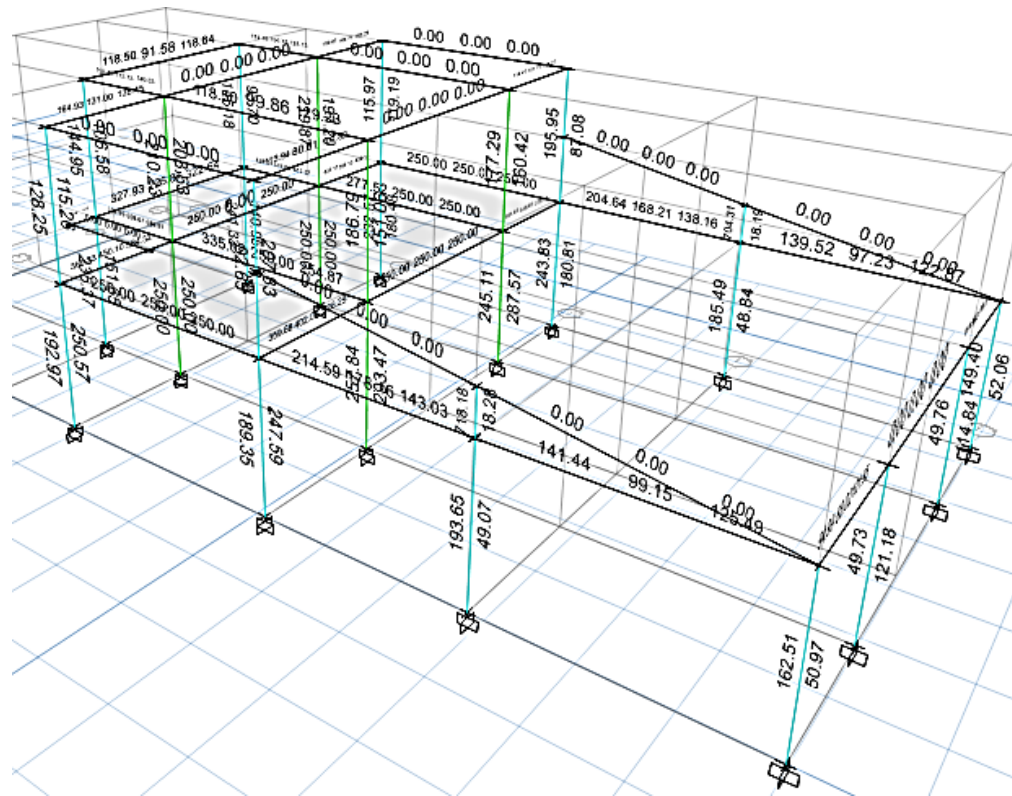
Refuerzo de acero por corte de la zona A, ETABS 2015. Fuente: Autor.
